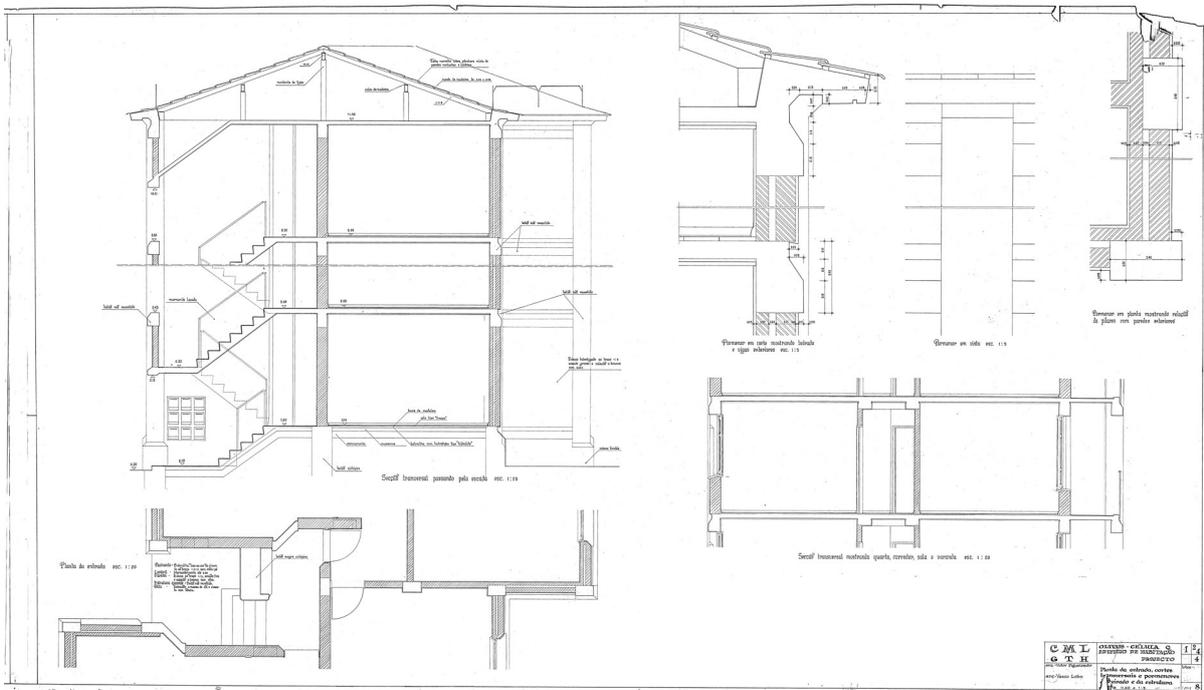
Projeto: planta da entrada, cortes transversais e pormenores do beirado e da estrutura
